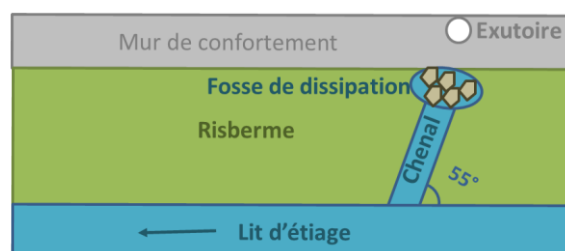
Aménagement de la risberme au droit des exutoires pluviaux en hauteur
